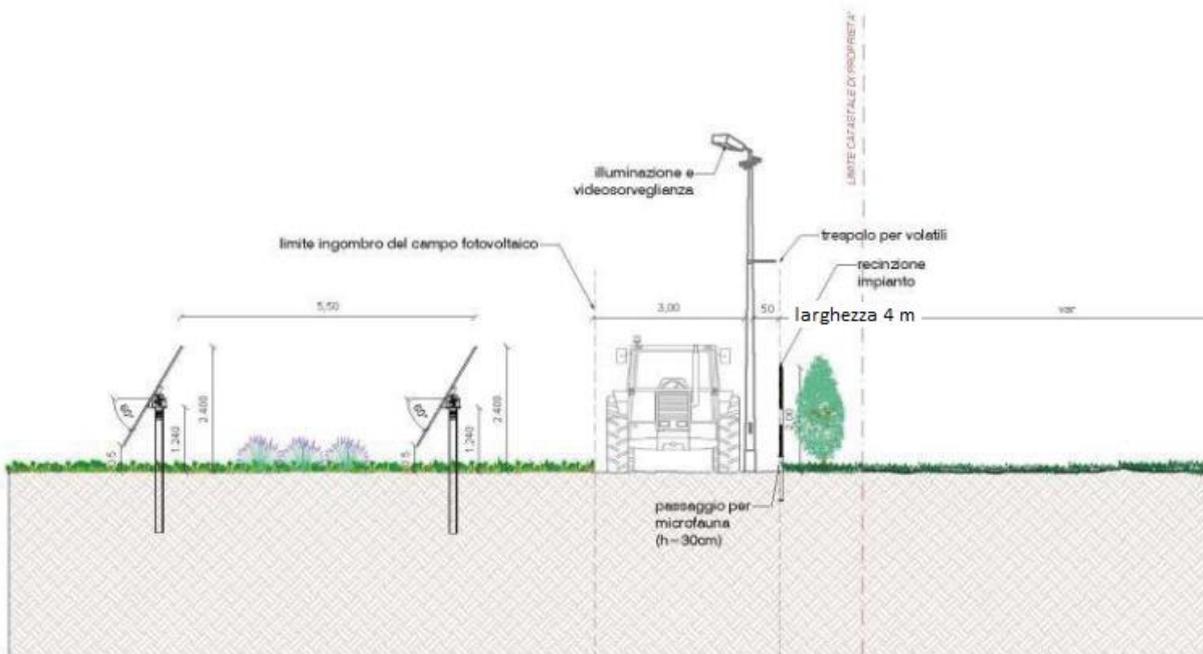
Sezione 2: Prospetto fascia di mitigazione perimetrale
